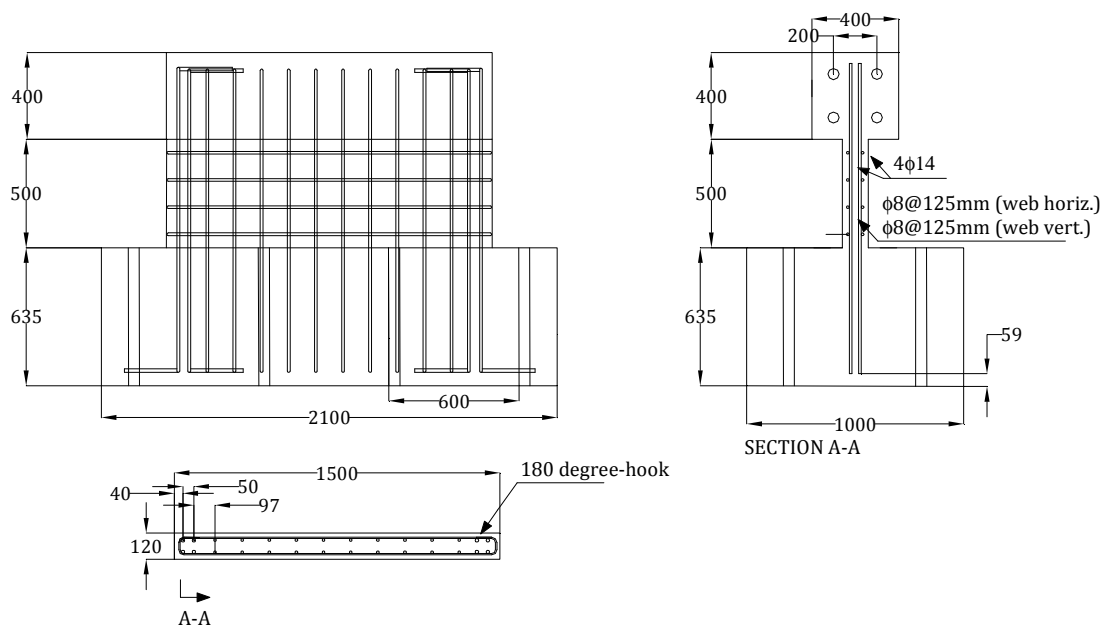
Geometría y detalle de armadura de muro Tipo 4
